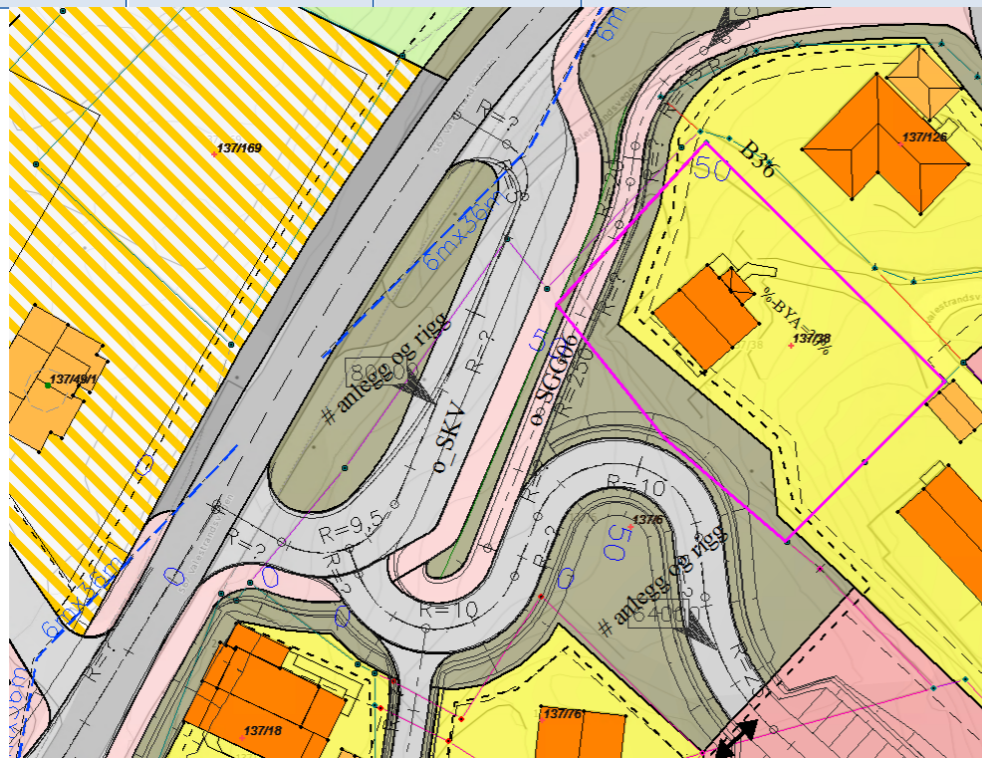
Situasjon framom «Tveitenhuset/banken» vist i framlegg til plan jf. Punkt 8. Ny inn- og utkøyring er forsterka med svart pil i illustrasjonen.
